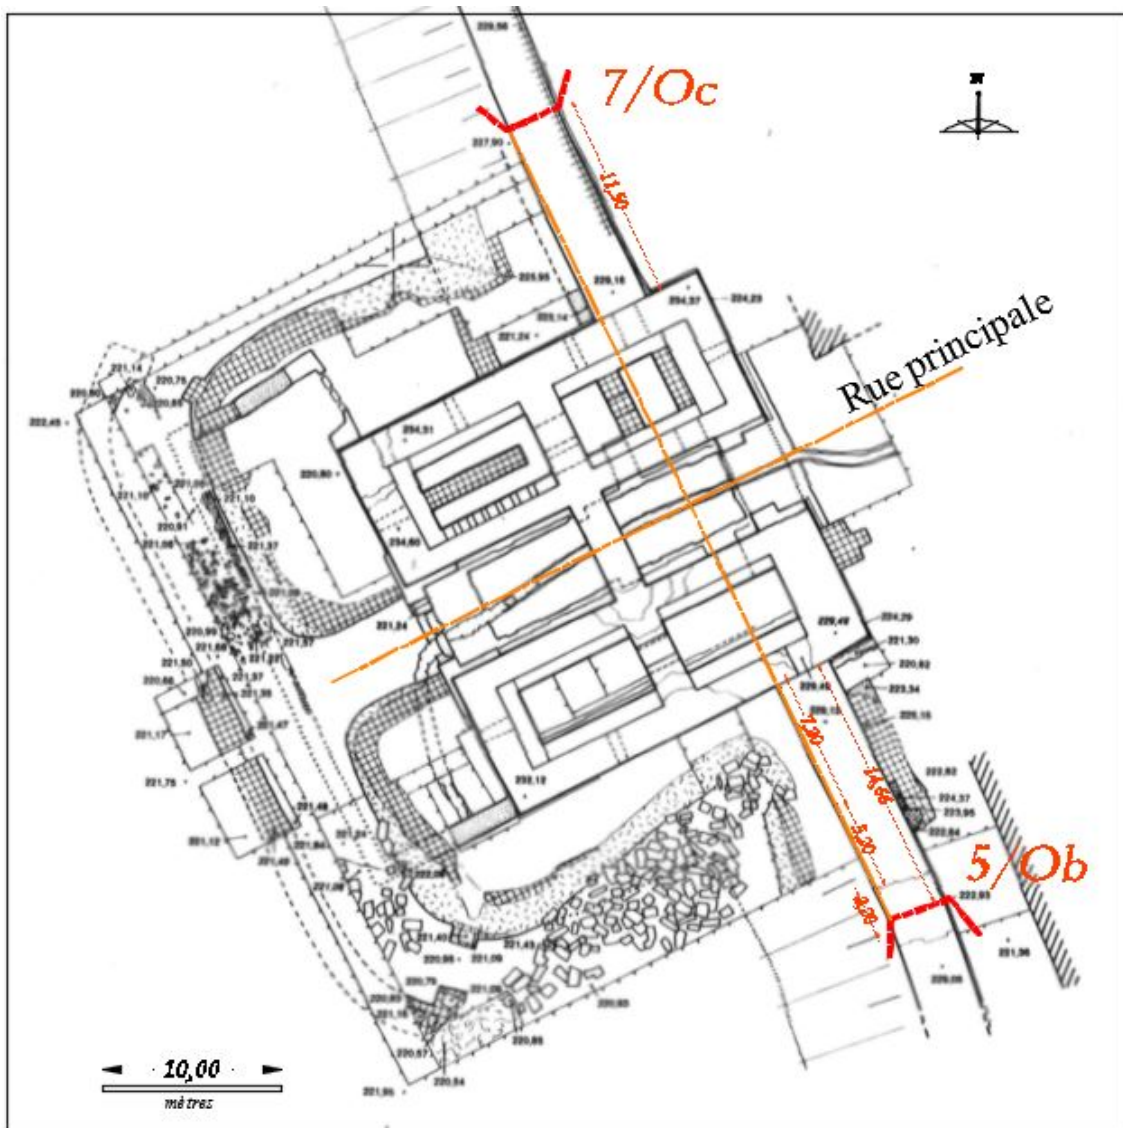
Plan du segment II : la porte de Palmyre et les deux murs de courtine en aile(MFSED).
